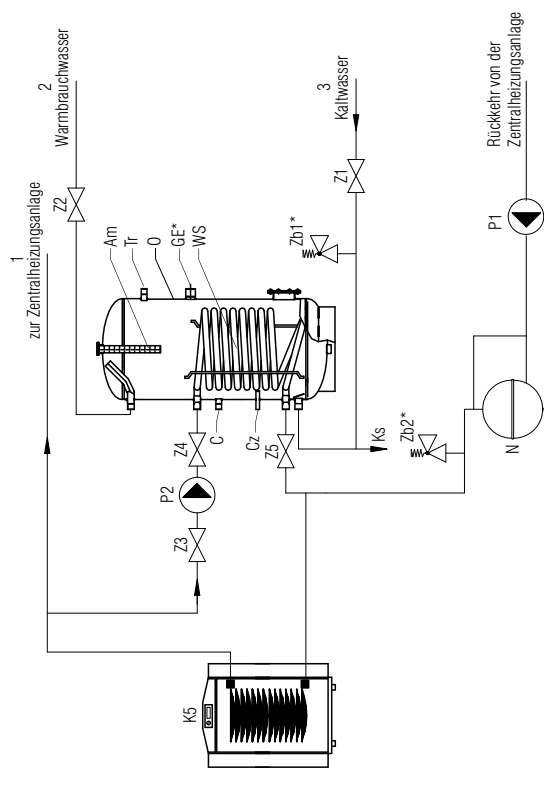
Montageplan des Wasser-Heizgerätes an den geschlossenen Kreislauf
